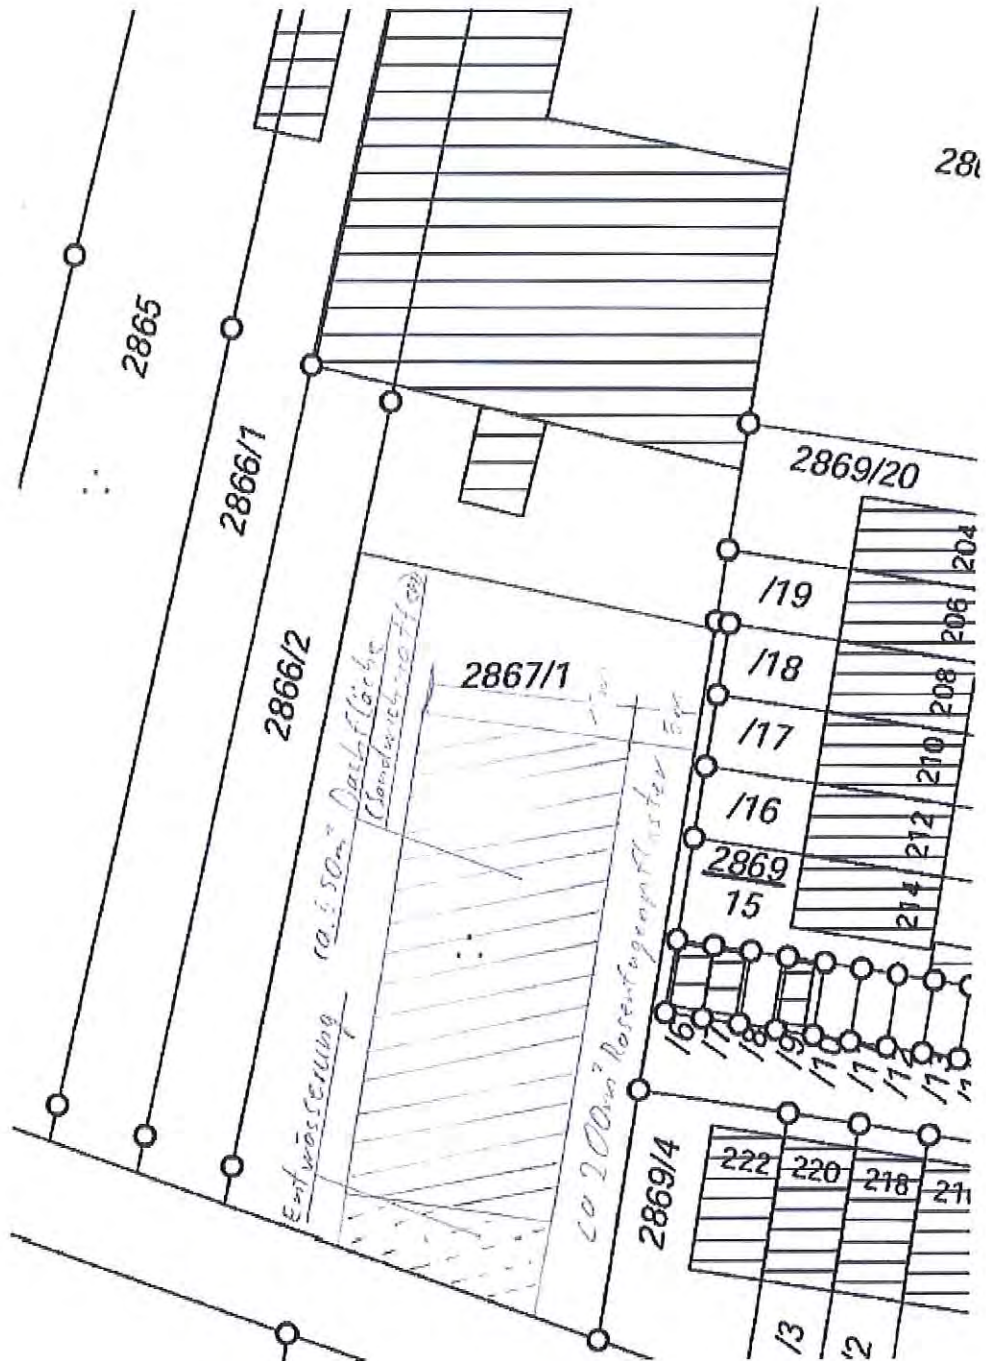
Skizze zur Lage der geplanten Halle und der Entwässerungsfläche (Quelle: Weiß Ingenieure)
